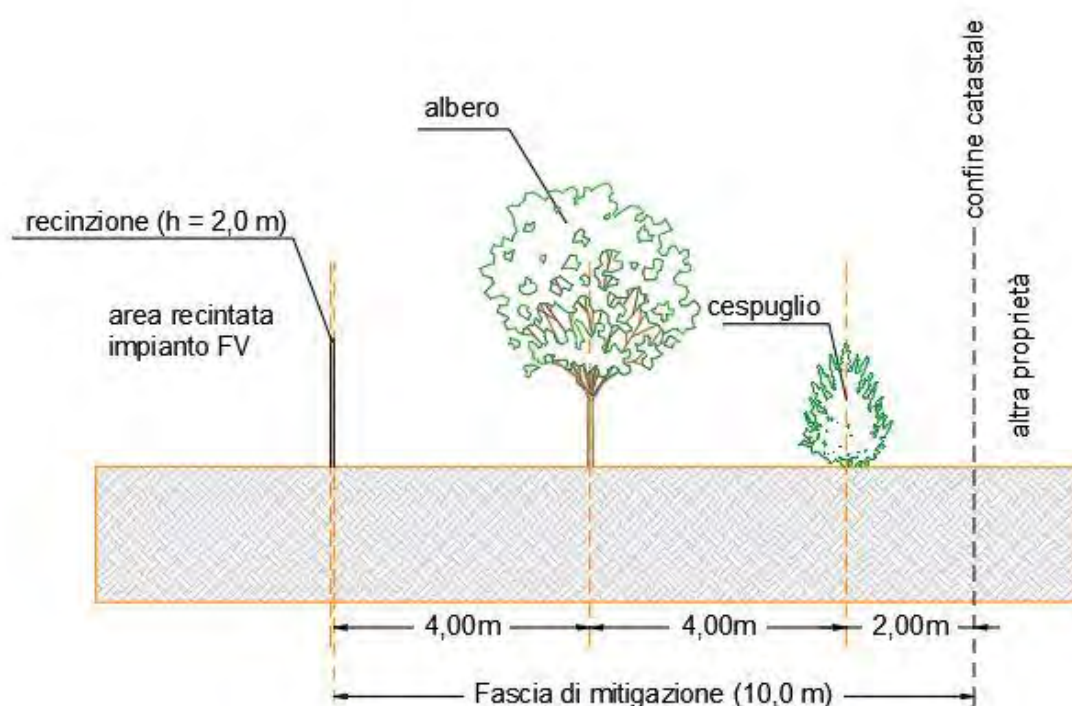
Stralcio di sezione dell'area perimetrale dell'impianto.
